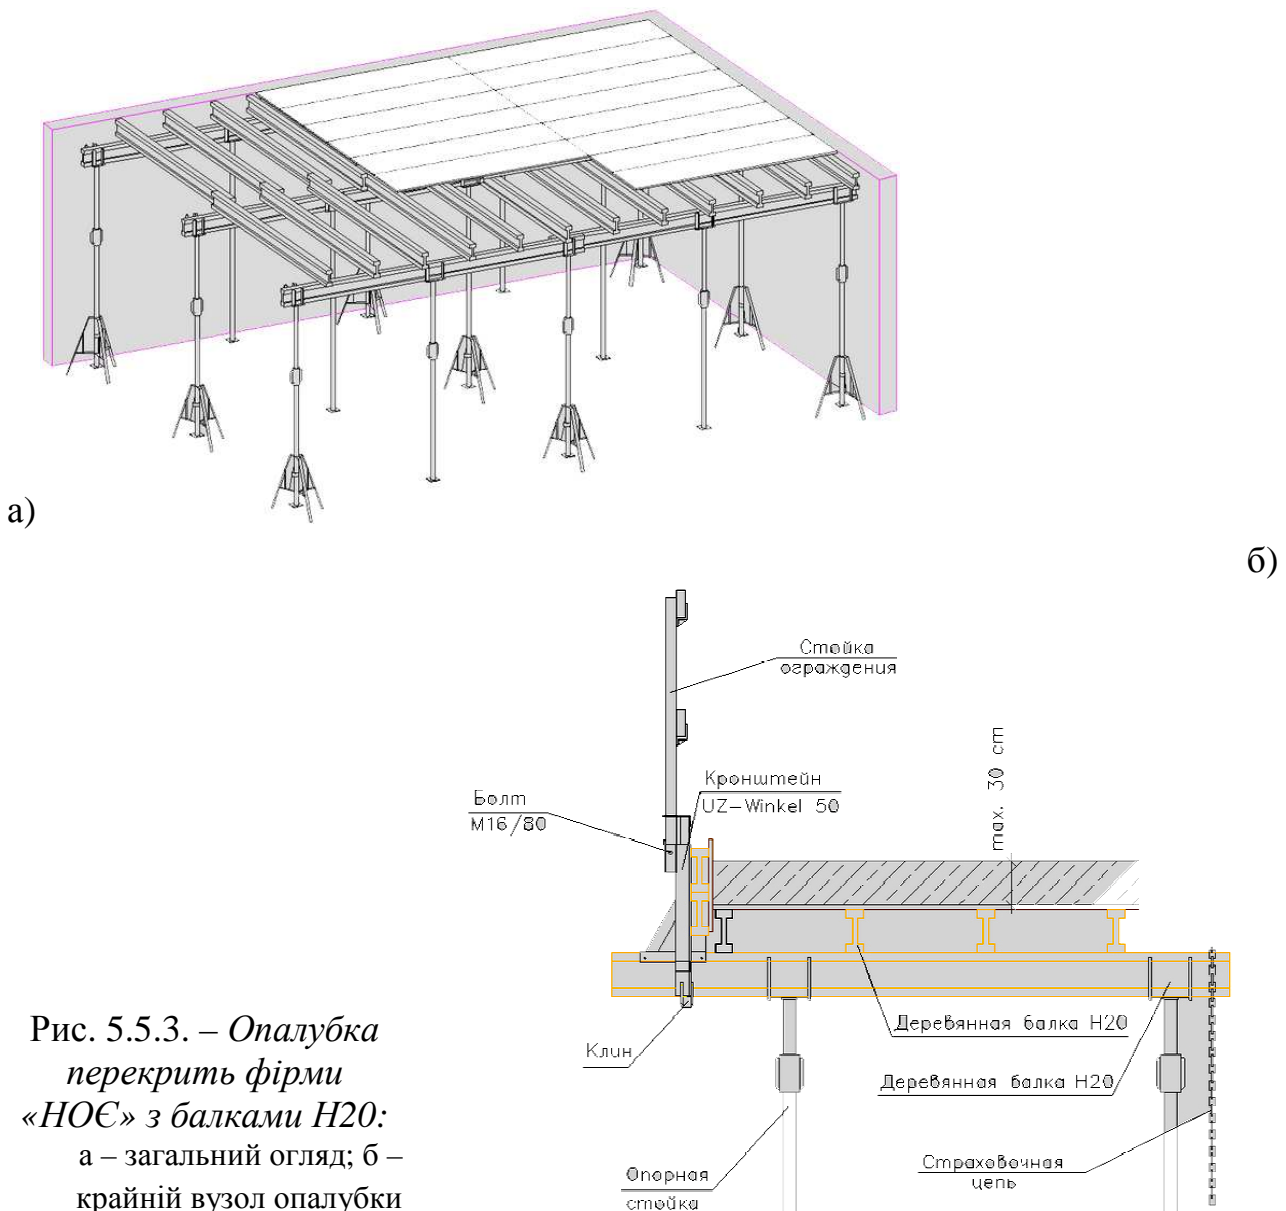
Опалубка перекрыть фірми «НОЄ» з балками H20:
